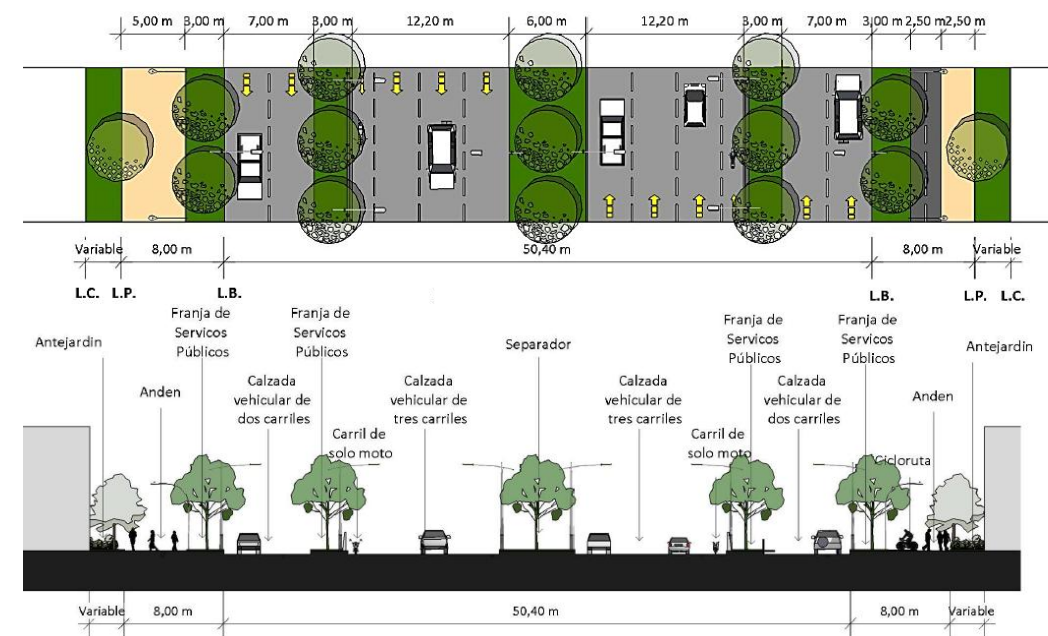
Planta y Perfil propuesto para la ampliación de la Av. Circunvalar. Fuente: Revisión Plan de Ordenamiento Territorial 2012.
